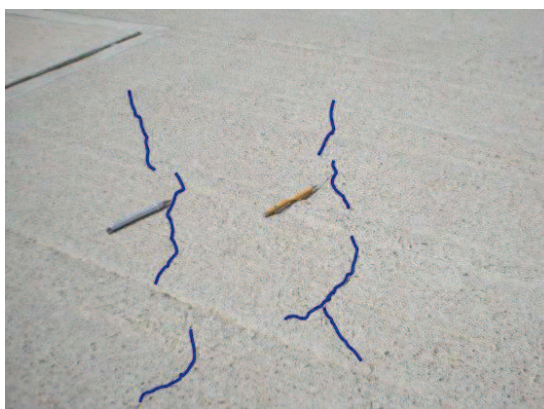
Fissuras de retração plástica, (Chodounsky, 2010).
